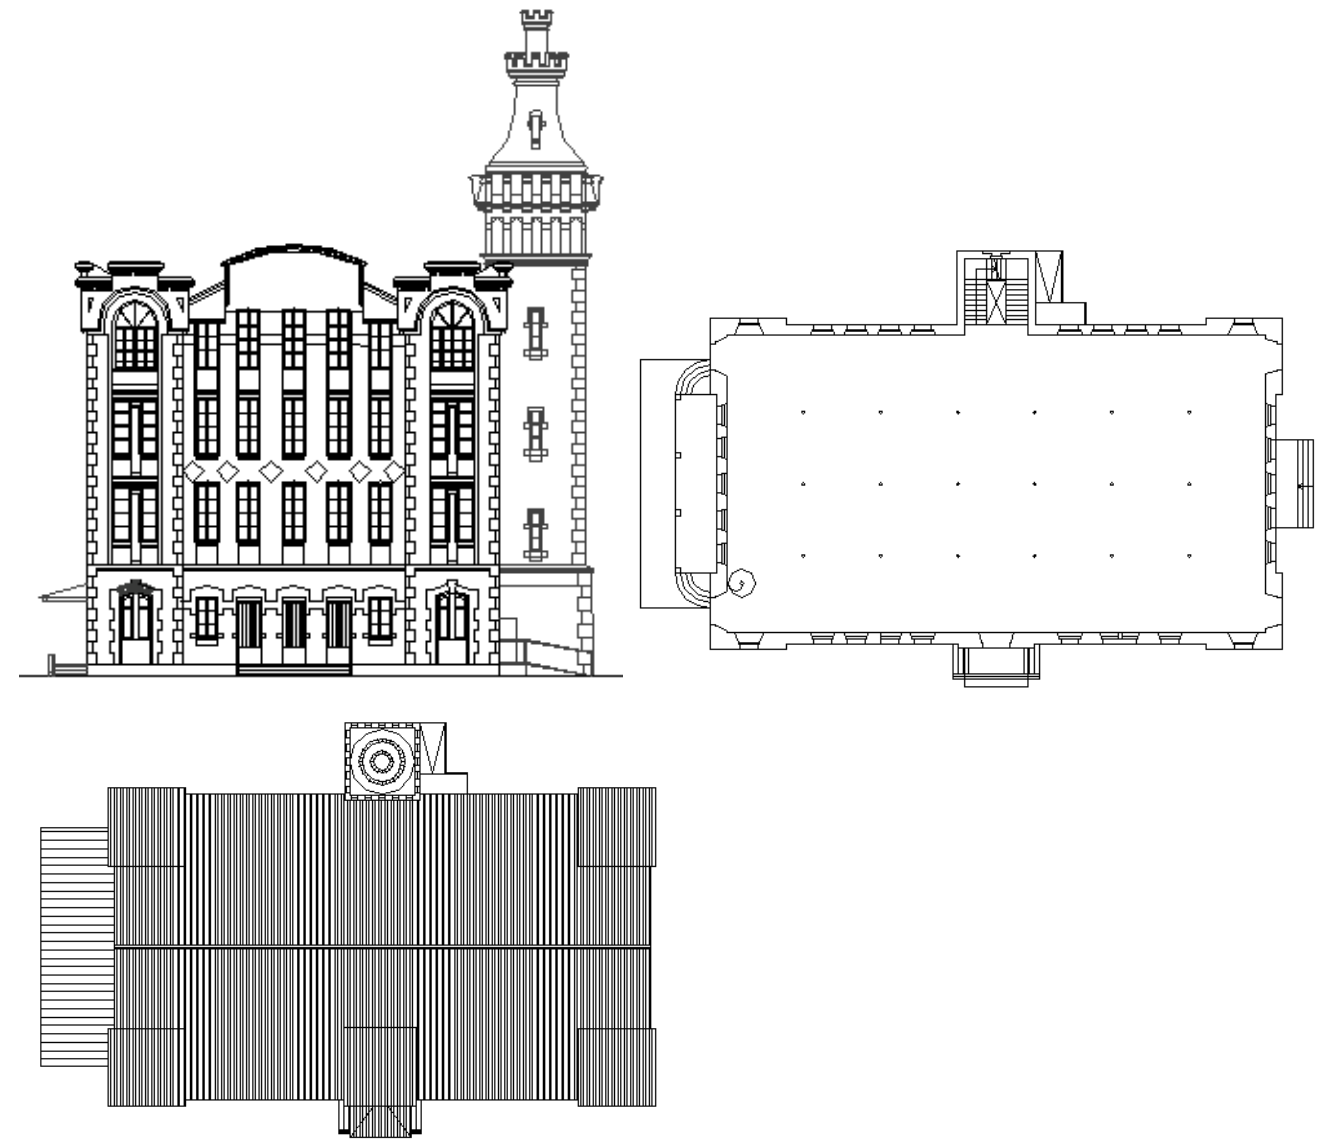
Aixecament de plànols de la Farinera: Façana nord-est, planta baixa i planta coberta fets amb Autocad.
